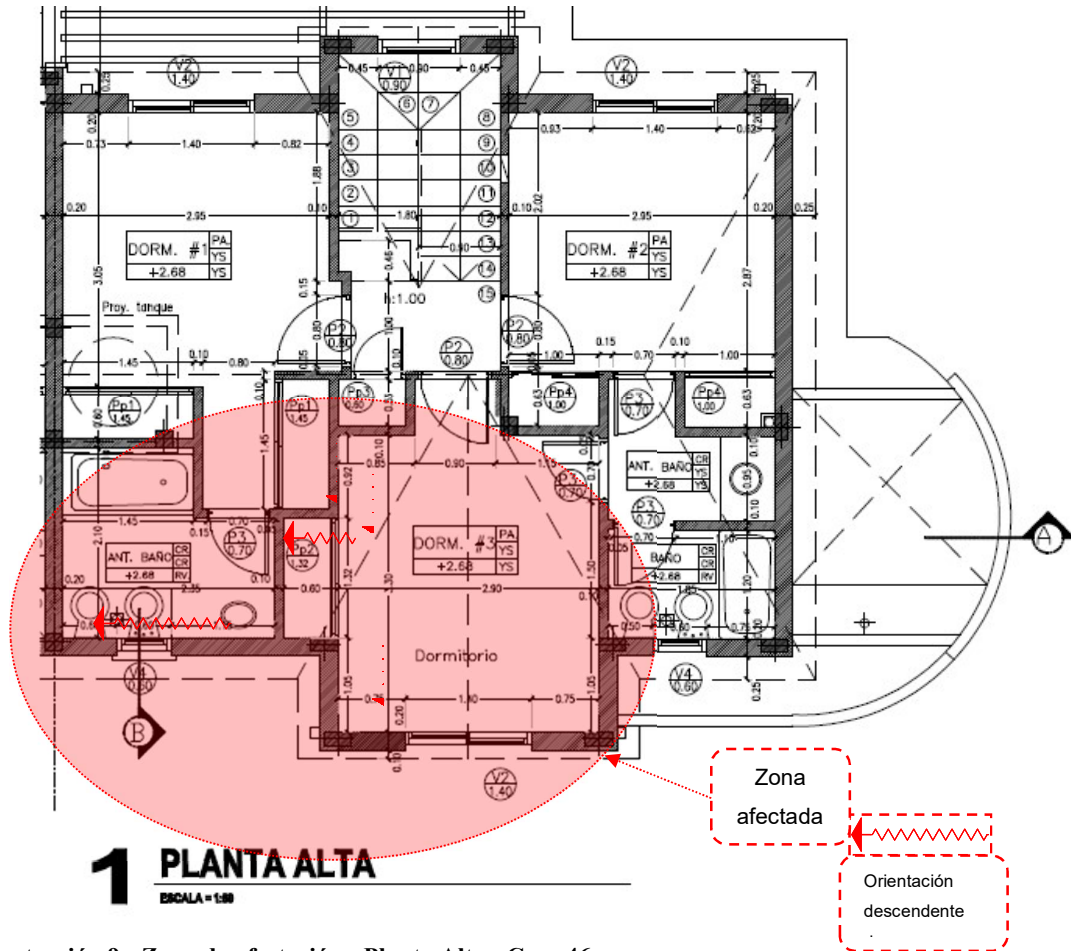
Zona de afectación - Planta Alta - Casa 46
